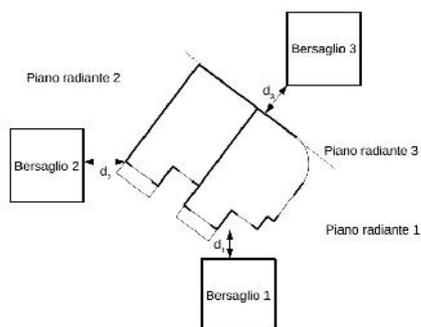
Determinazione del piano radiante (vista in pianta delle costruzioni)
